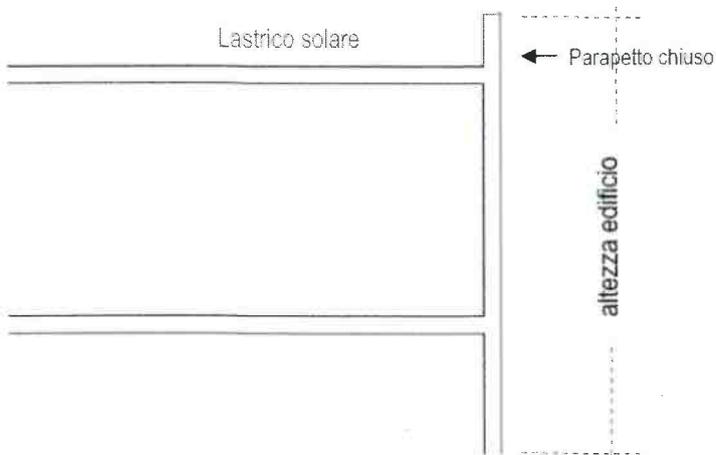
Edificio con copertura piana parapetto chiuso e lastrico solare o terrazza.
